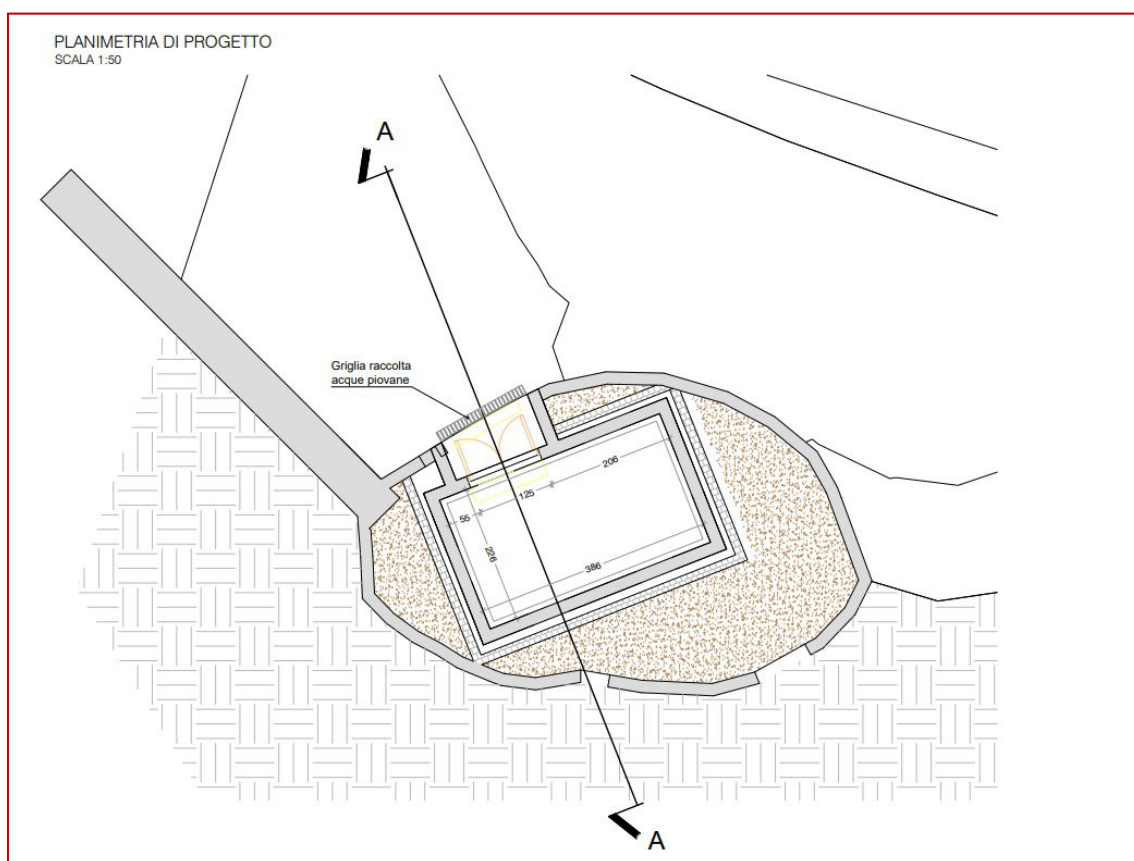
Estratto TAV. 02 di progetto - Dettaglio planimetria
